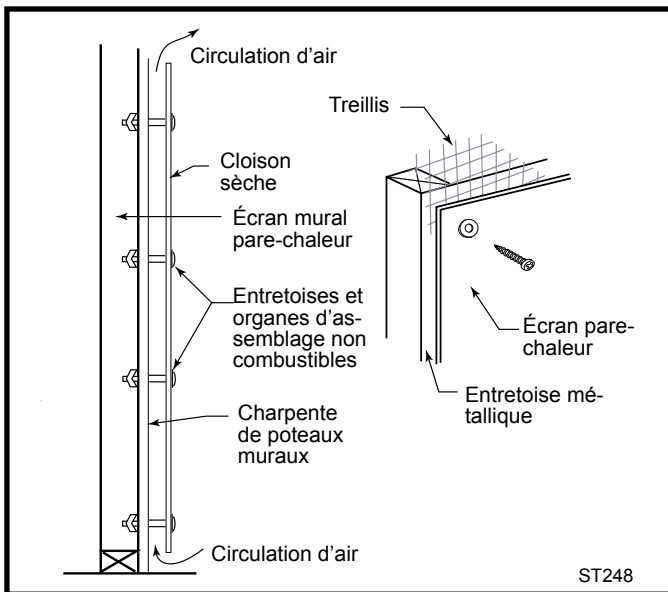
Construction approuvée de l'écran mural pare-chaueur.
